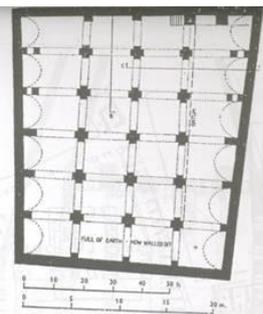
مسقط أفقي لمسجد قصر جبل سيس . (عن ، كريزول).
